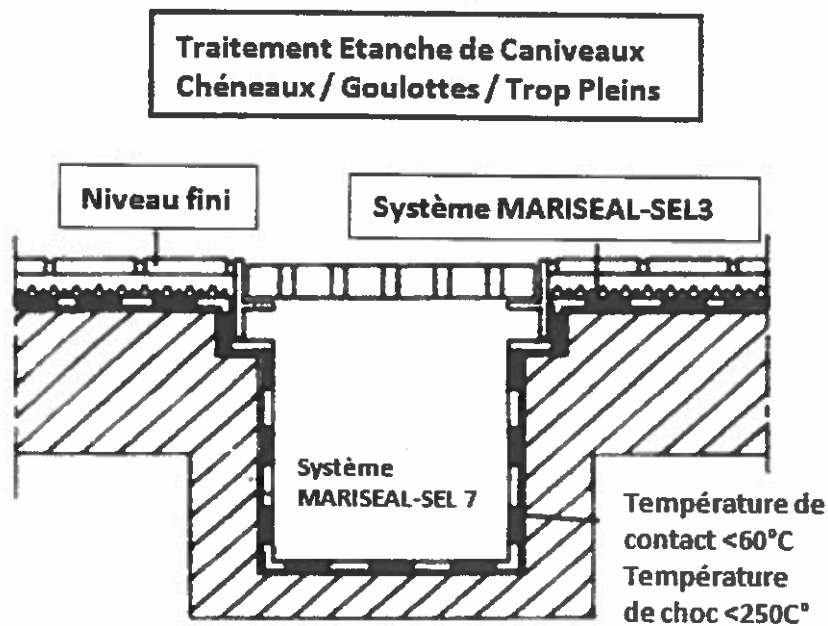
Traitement étanche de Caniveaux / Chéneaux/Goulottes/Trop pleins
